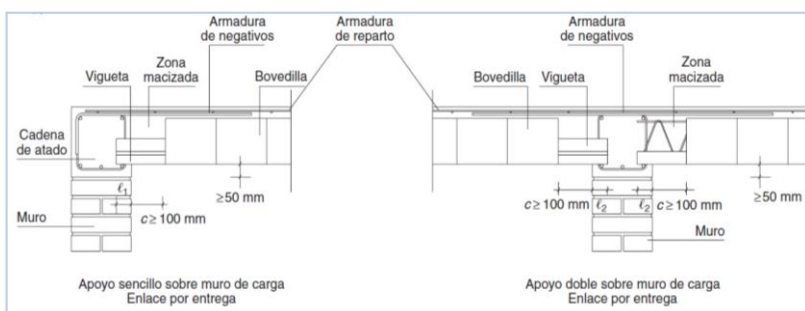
y 20. Apoyo sobre muro de carga. Enlace por entrega
